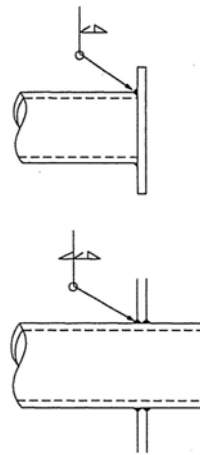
単一鋼管部材の端部の溶接方法 ($d \leq l/25$)
